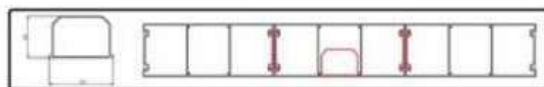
Esquema em planta do perfil canaleta dentro do módulo básico
